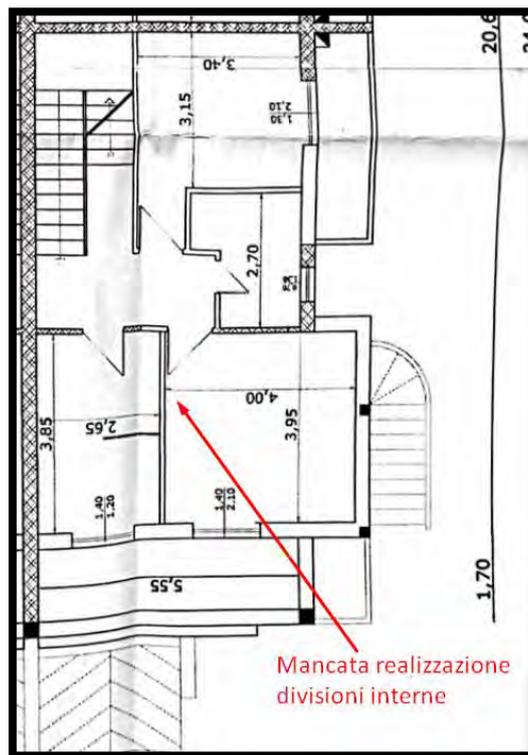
Pianta piano secondo allegata alla CILA prat. n. 294/2011
